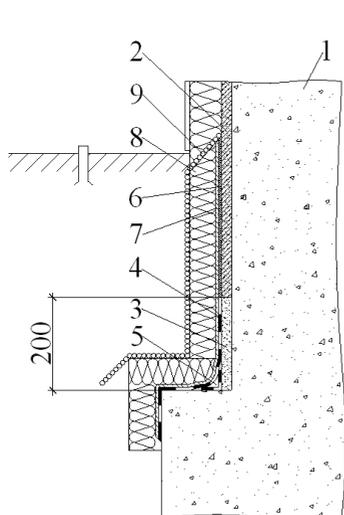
Схема устройства гидроизоляции конструкций фундаментов с использованием материалов системы Реммерс
